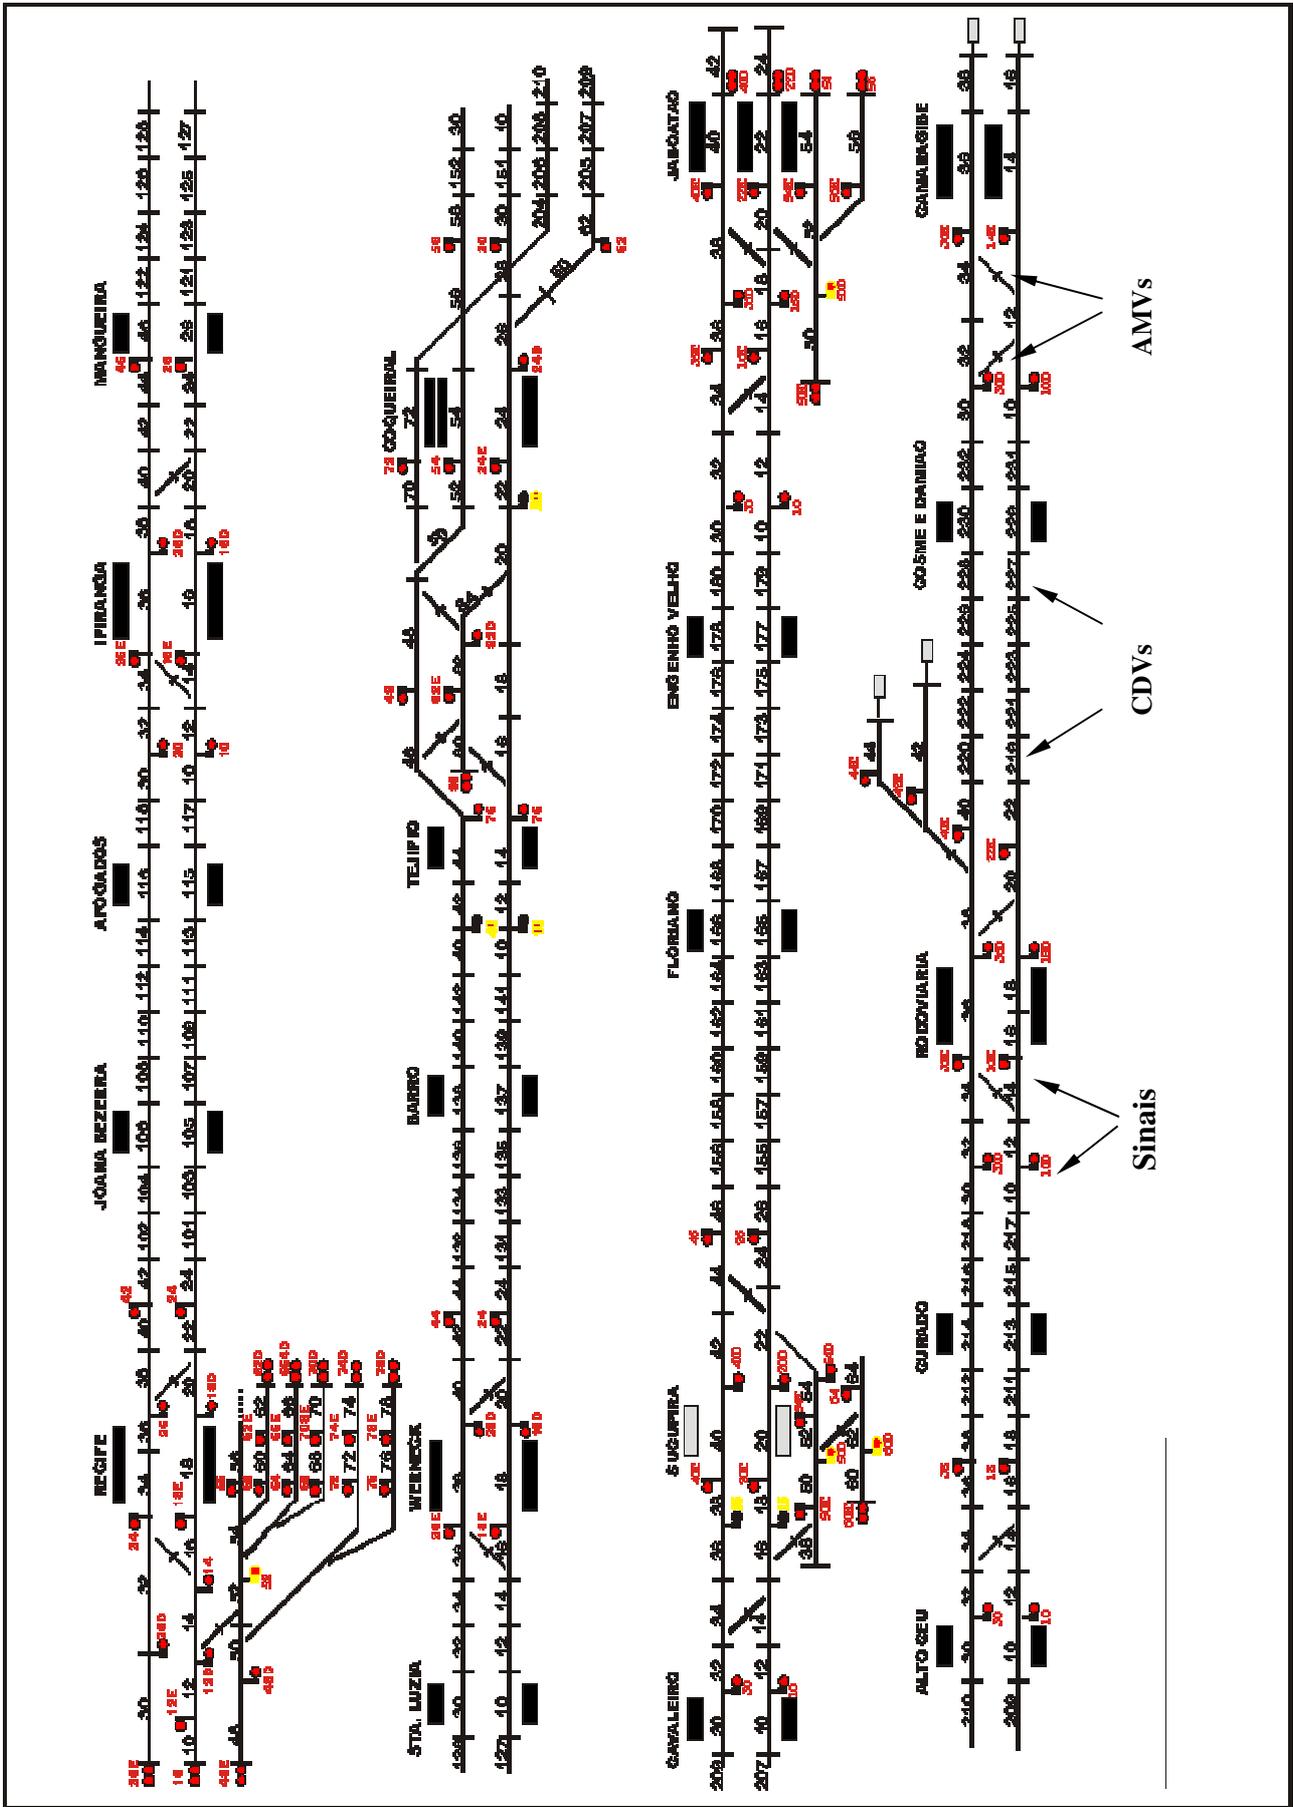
Plano de Vias e Sinais da Linha Centro – STU-REC
